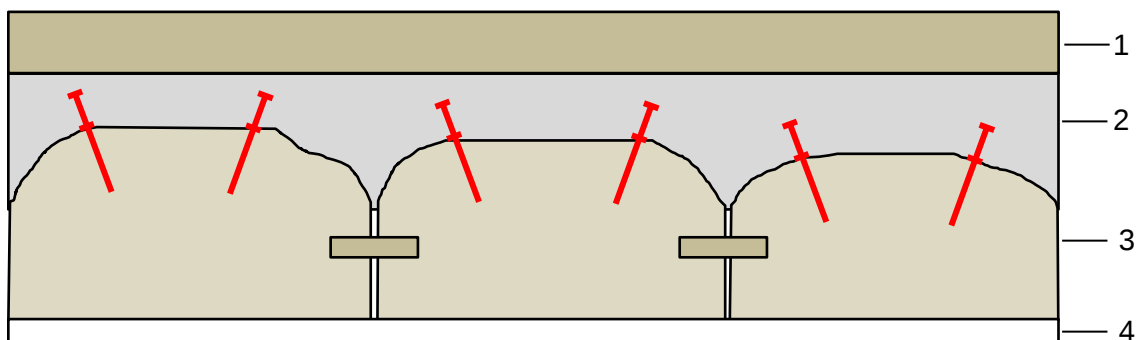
Schematischer Aufbau einer Holz-Beton-Verbunddecke
